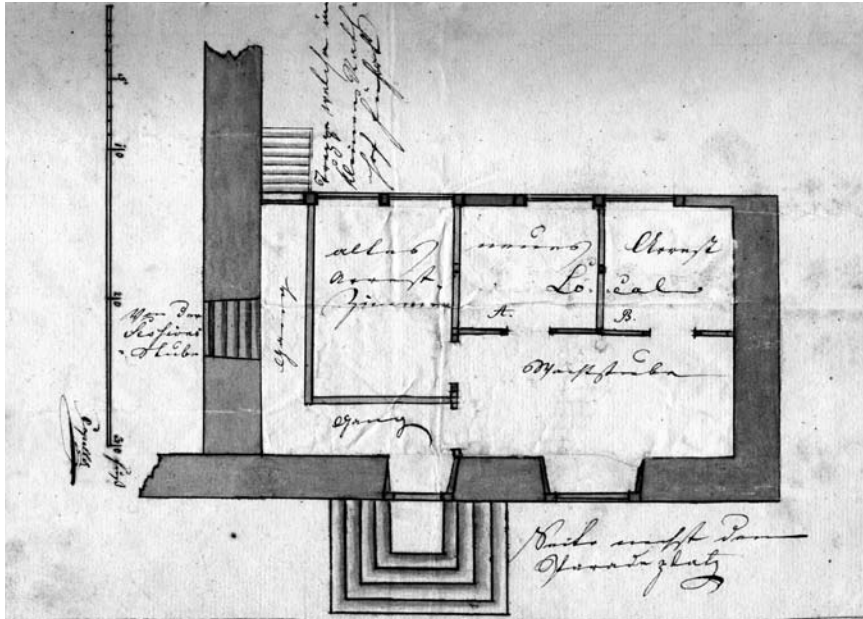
Grundriss des Südflügel-Erdgeschosses nach dem Umbau mit drei Arrestzellen 1823. Aus Stadtarchiv Soest B XXI a 12
